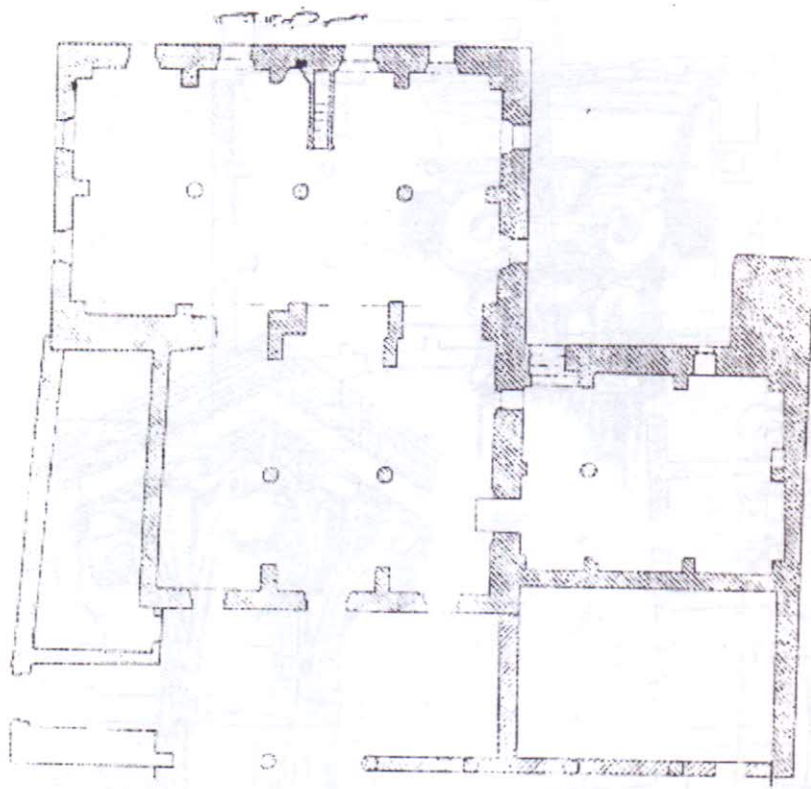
المسقط الأفقي للجامع العتيق - درنة - ليبيا
